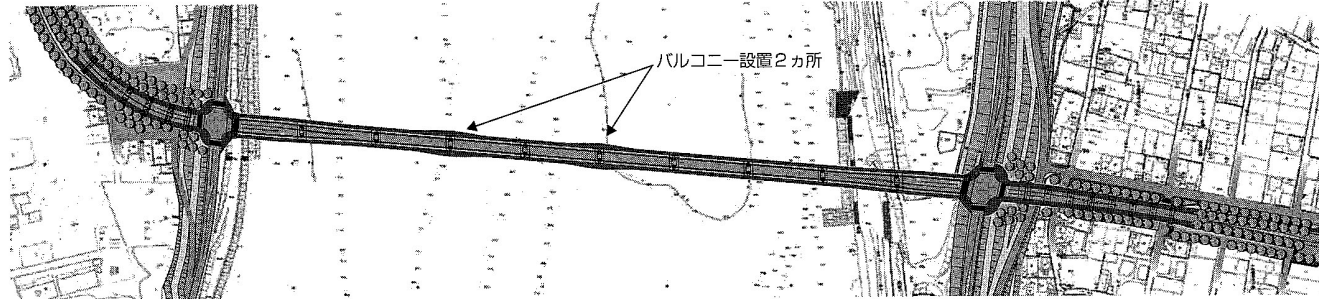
平面図抜粋 (予備設計範囲である本橋およびアプローチ道路)
